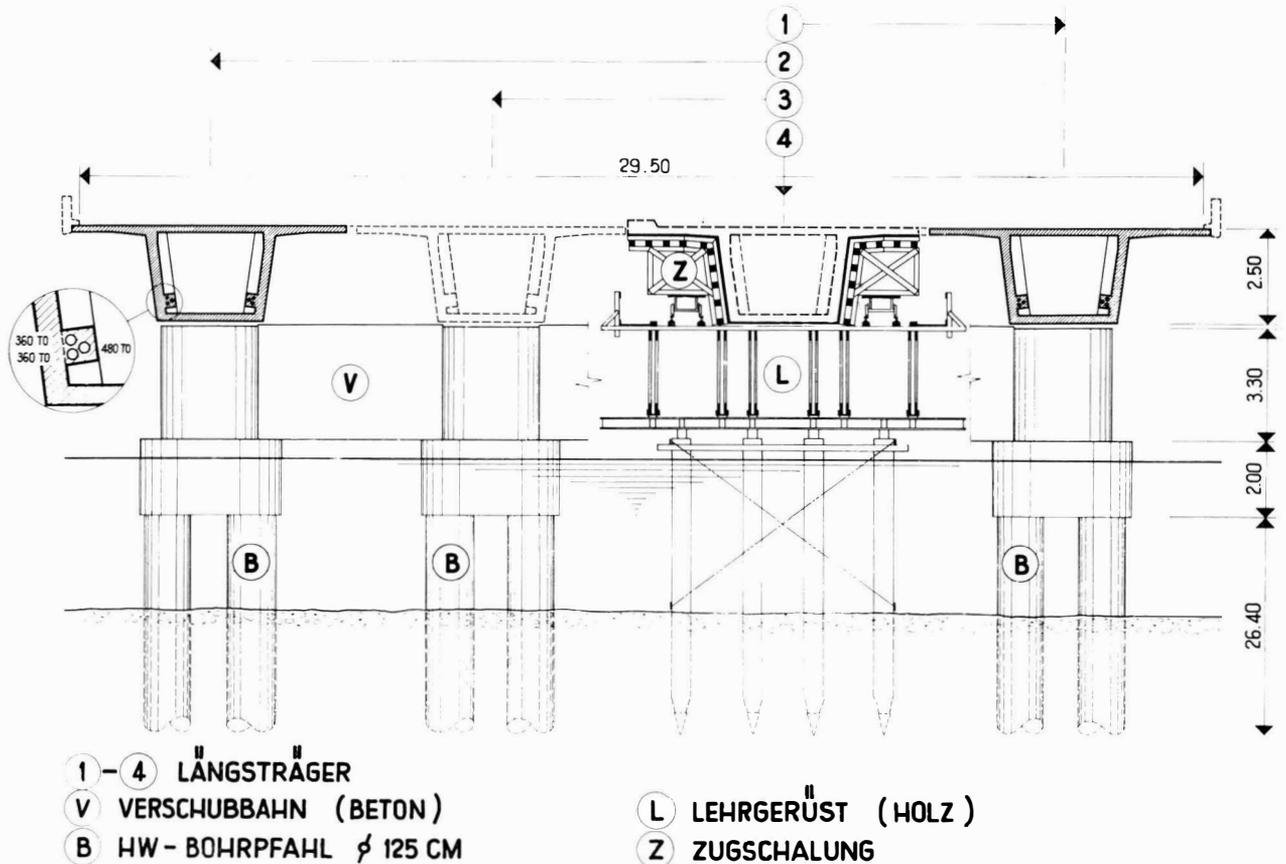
Querschnitt und Bauvorgang, Gründung mit HW-Bohrpfählen
